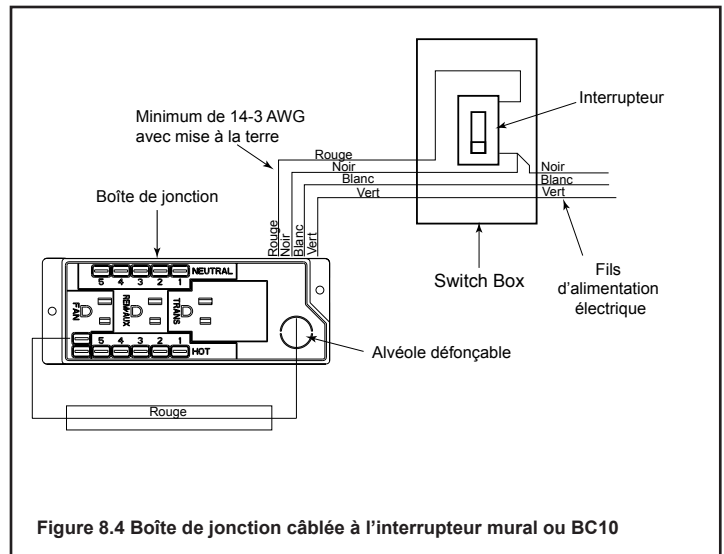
Boîte de jonction câblée à l'interrupteur mural ou BC10
